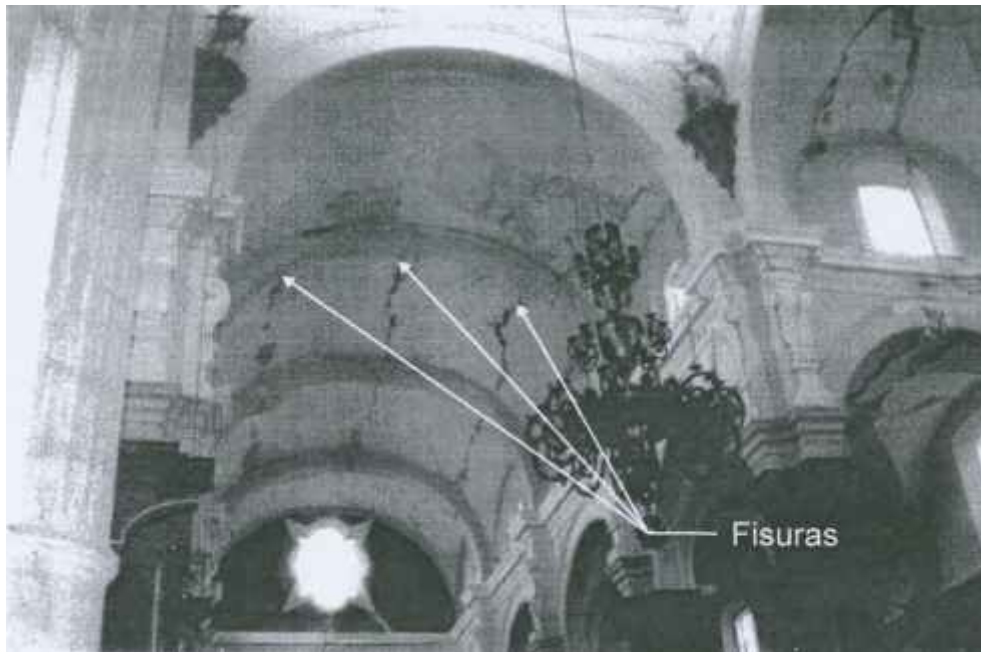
Fisuras estructurales observadas en el Templo de la Compañía
